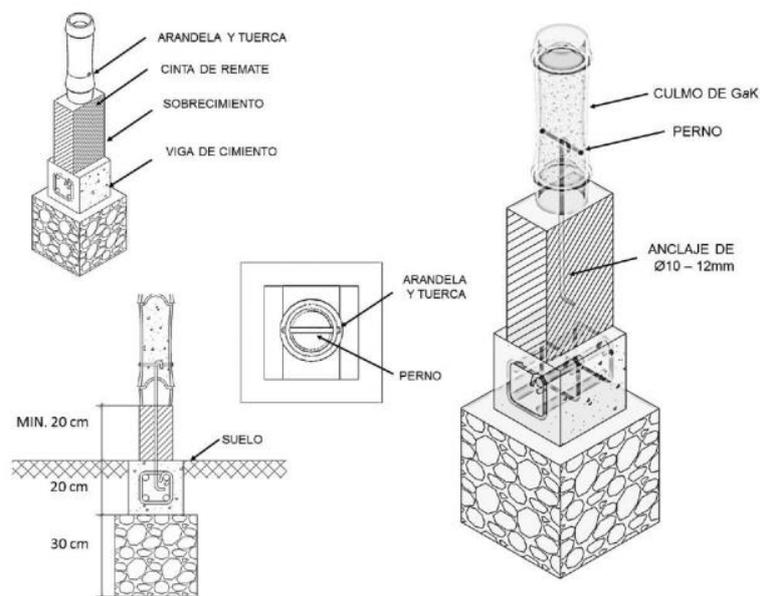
Detalle de apoyo de columnas de GAK en sobrecimiento
